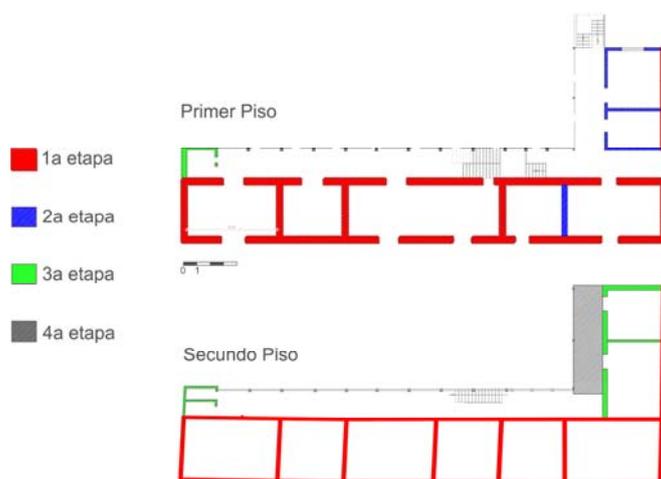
Etapas constructivas de la Casa de Jorge Isaacs
